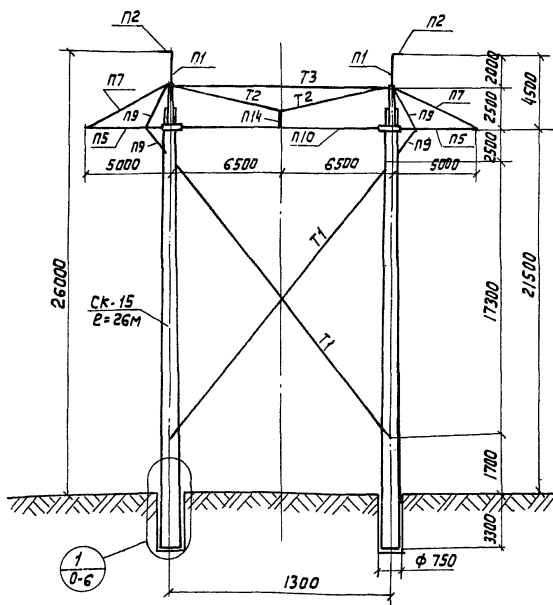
Промежуточная железобетонная опора ПБ500-5Н
